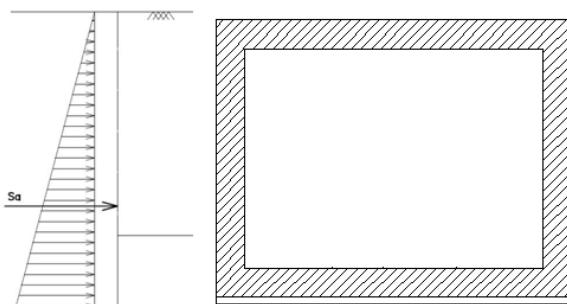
Schema per il calcolo degli effetti della spinta statica del terreno
